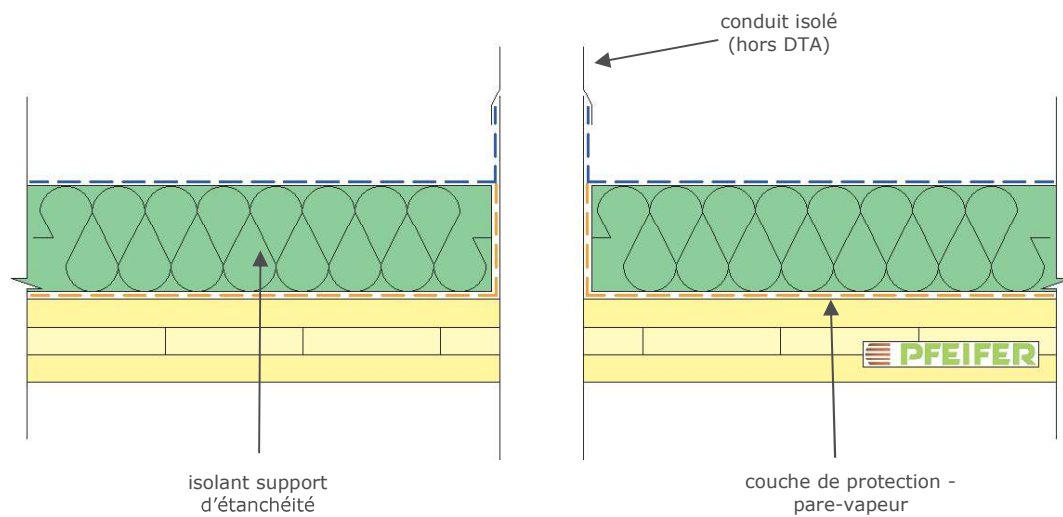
Exemple de relevé en terrasse accessible aux piétons et au séjourFigure A.9 – Descente des eaux pluviales en terrasse accessible aux piétons et au séjour
